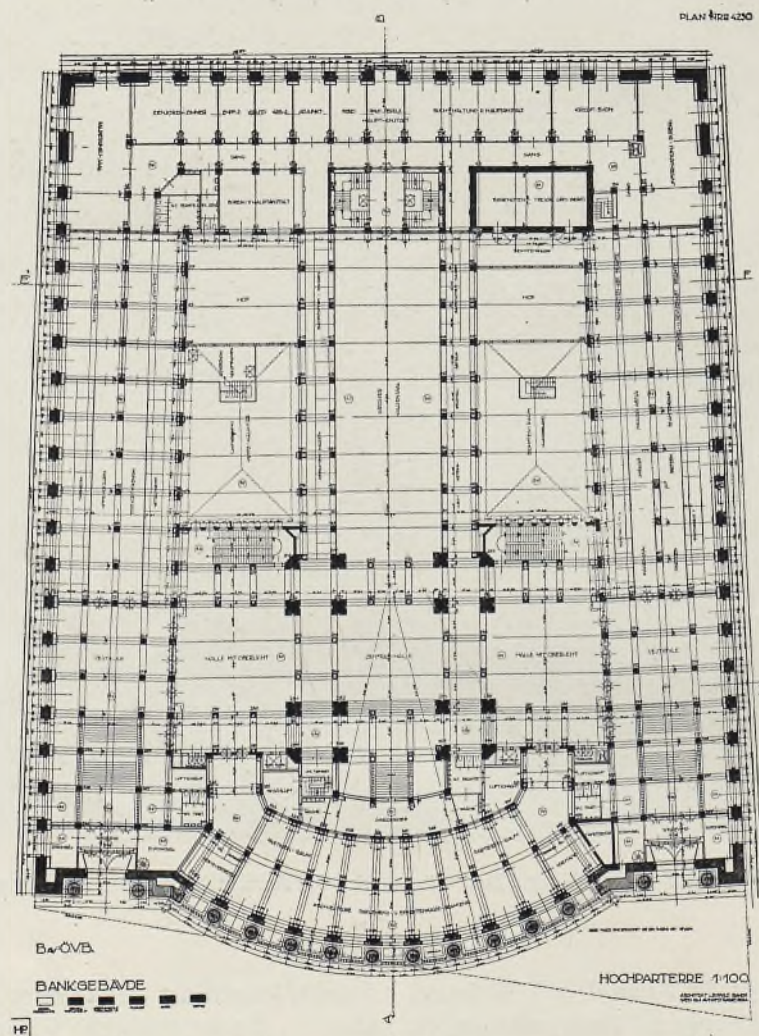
Bau der Österr.-Ungar. Bank, Grundriß (Hochparterre). Architekt Oberbaurat Professor Leopold Bauer.
